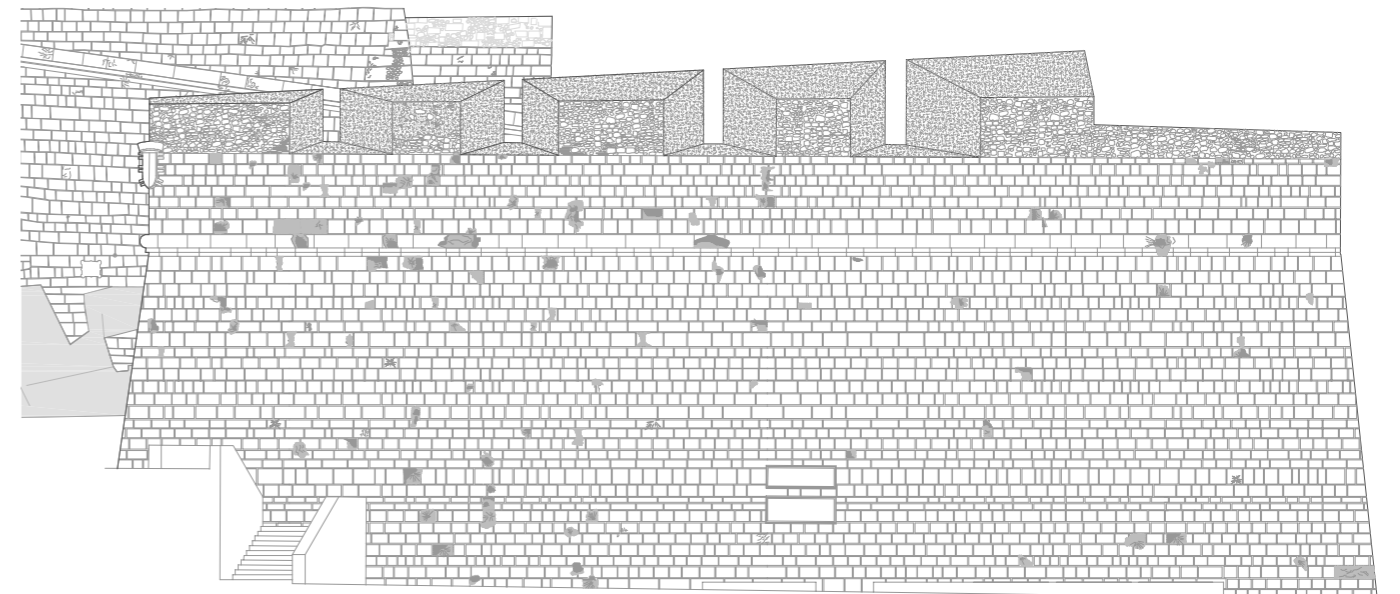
Alzado del lienzo exterior del baluarte de Santa María. Plano del proyecto de restauración. (MJB 2001).
